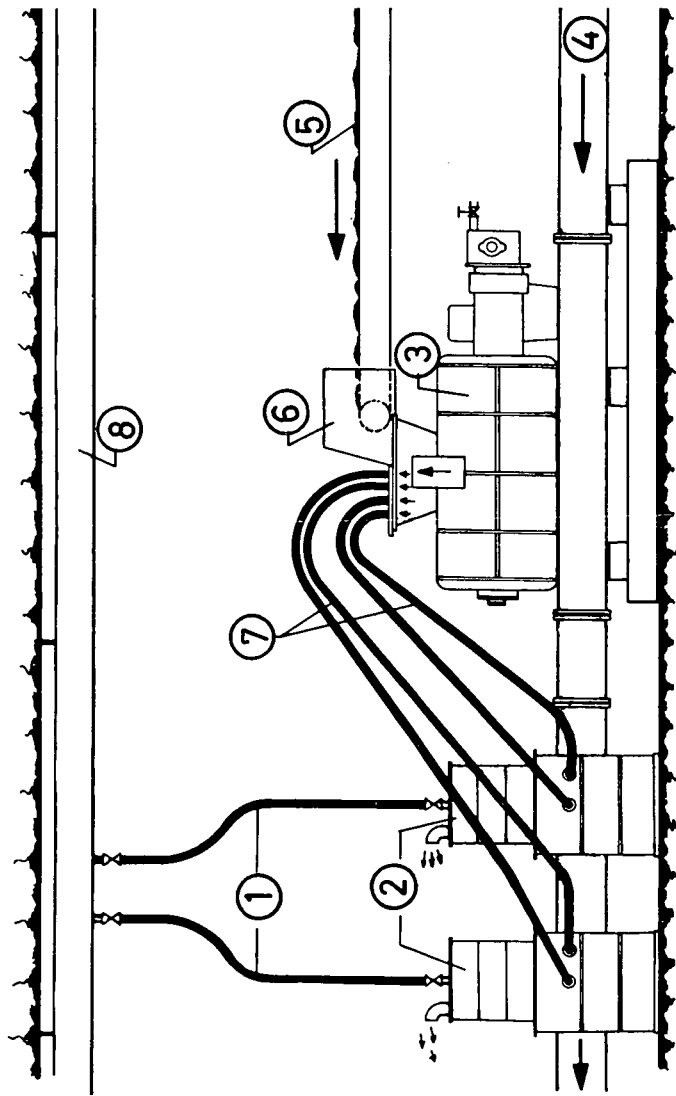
Remblayeuse pneumatique avec dispositif de captage des poussières par aspiration.
